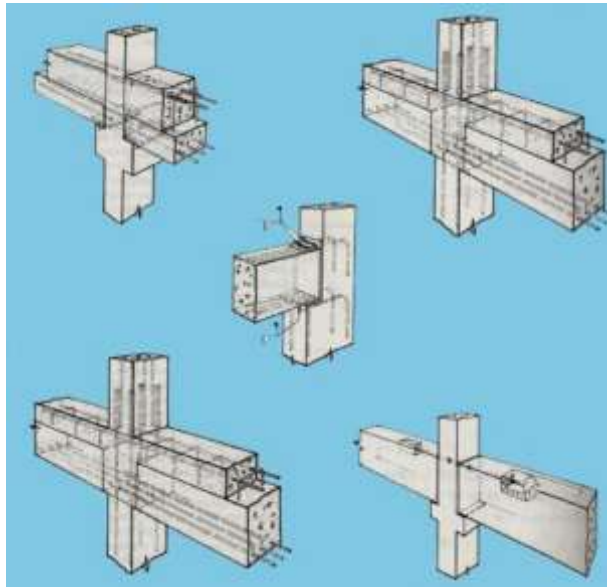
Detalles típicos de conexiones prefabricados viga-columna.
